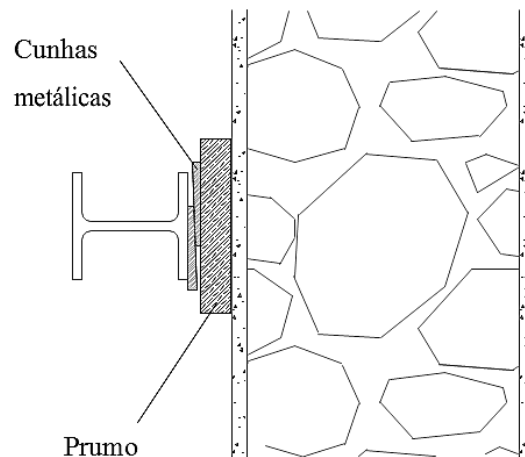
Ligação indireta da estrutura de suporte [7]
